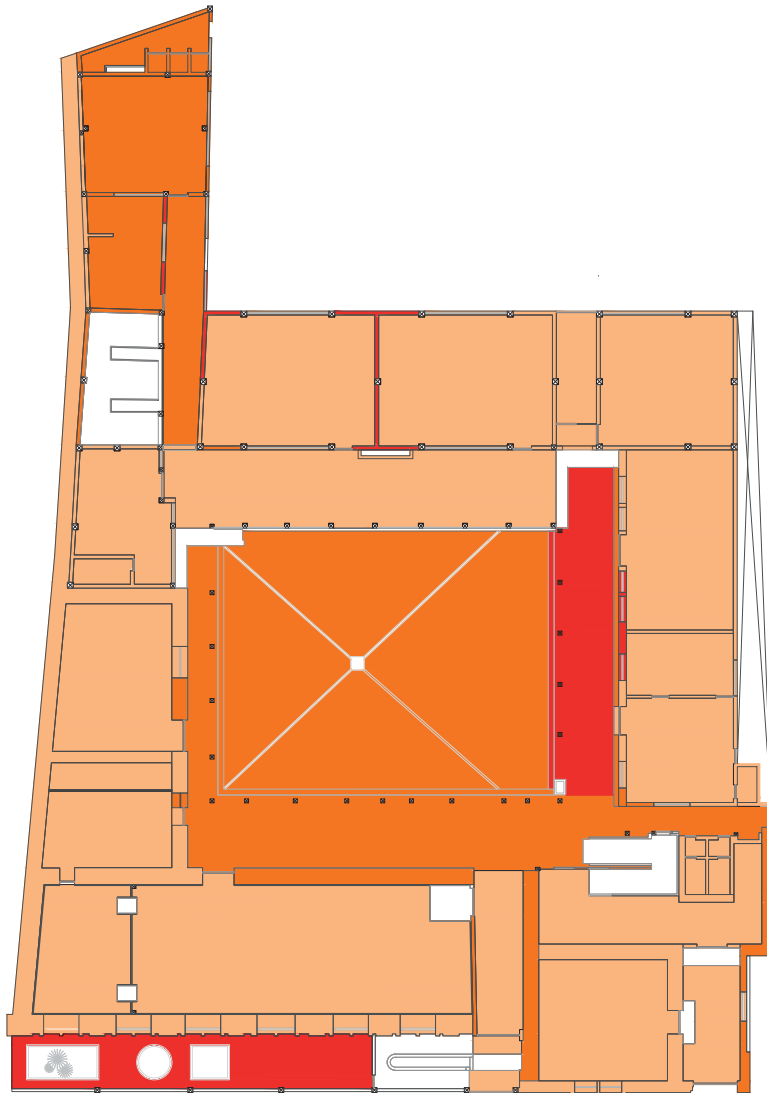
Estado de conservación de pisos,muros, carpinterías, planta baja
